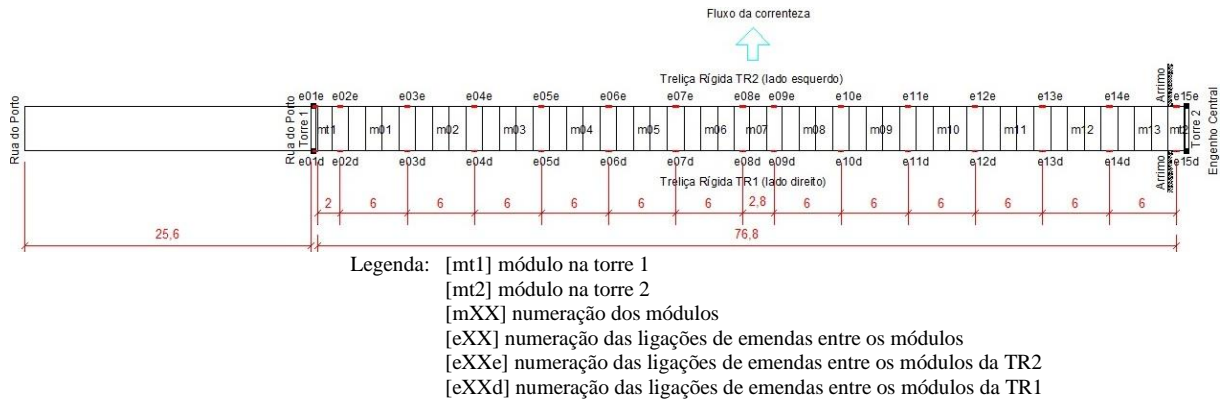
Esquema unifilar em planta da passarela pênsil: posição das vigas de rigidez treliçadas, numeração dos módulos [mXX] e numeração das ligações das emendas [eXX] dos módulos.
